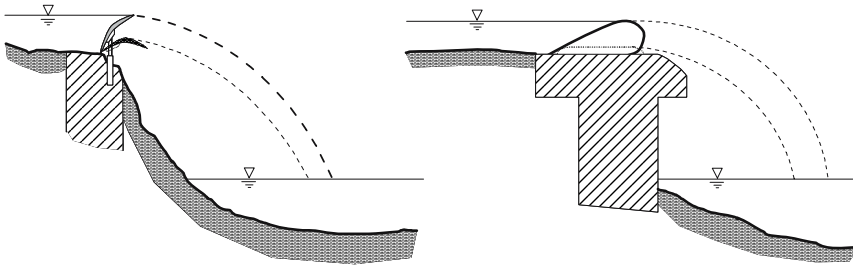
Querschnitt durch eine Wehranlage mit aufgesetzter Fischbauchklappe (links) und mit aufgesetztem Schlauchwehr (rechts) (nach /7-9/)
